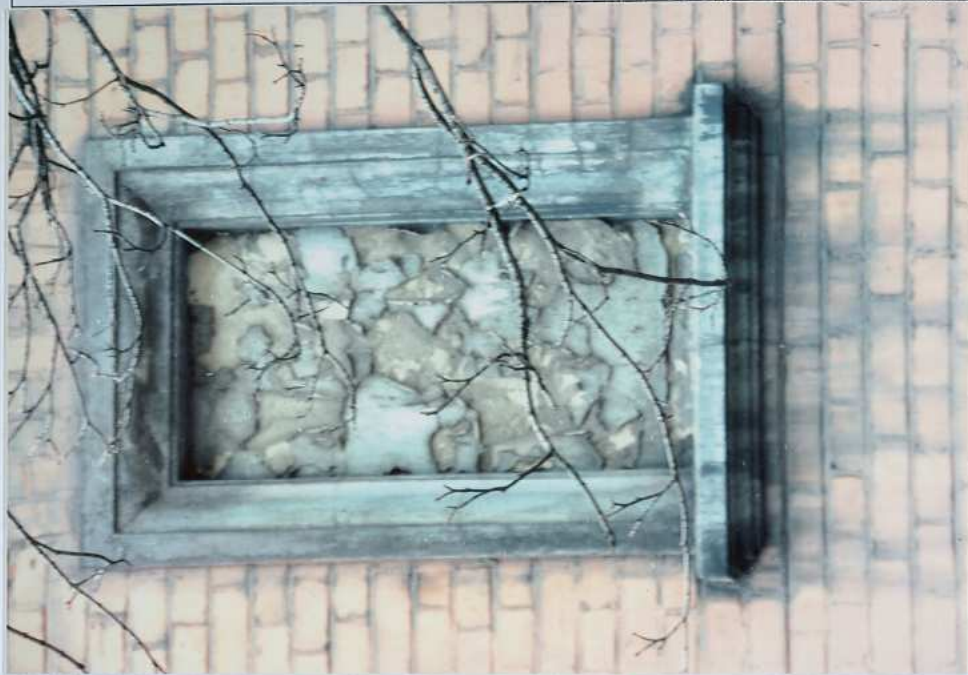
Okno pierwszego piętra – elewacja zachodnia.
